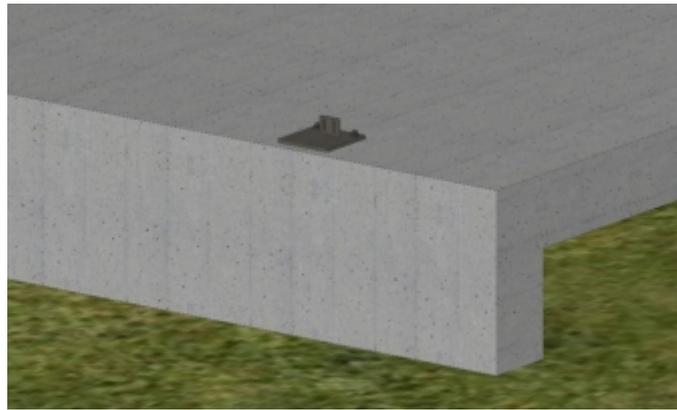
Positionnement et fixation de la patte d'implantation sur le béton
